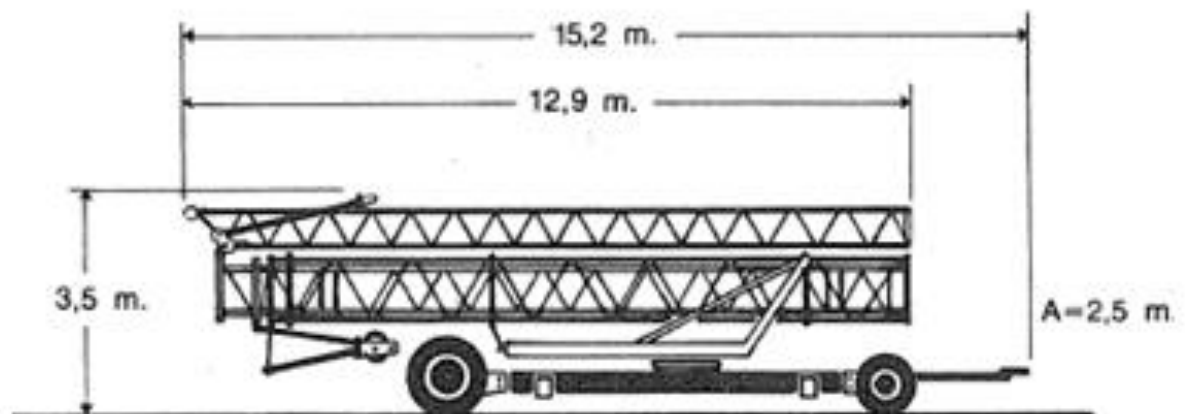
Grúa autodesplegable fija plegada
